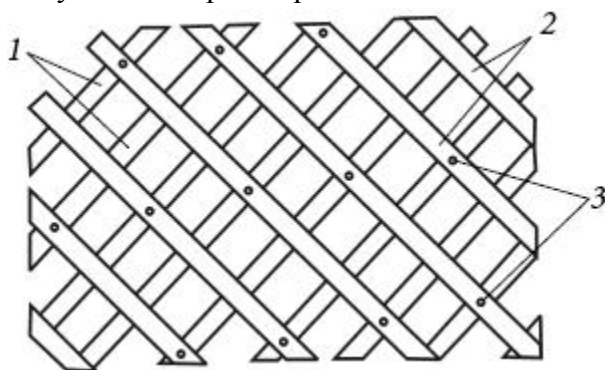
Схема набивки драни под штукатурку: 1) простильный ряд; 2) выходной ряд; 3) крепление гвоздями
